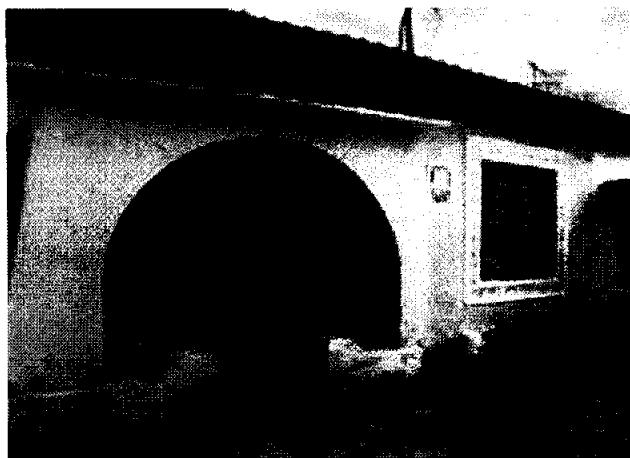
Foto C: Outra perspectiva da Fachada da casa residencial avalianda
